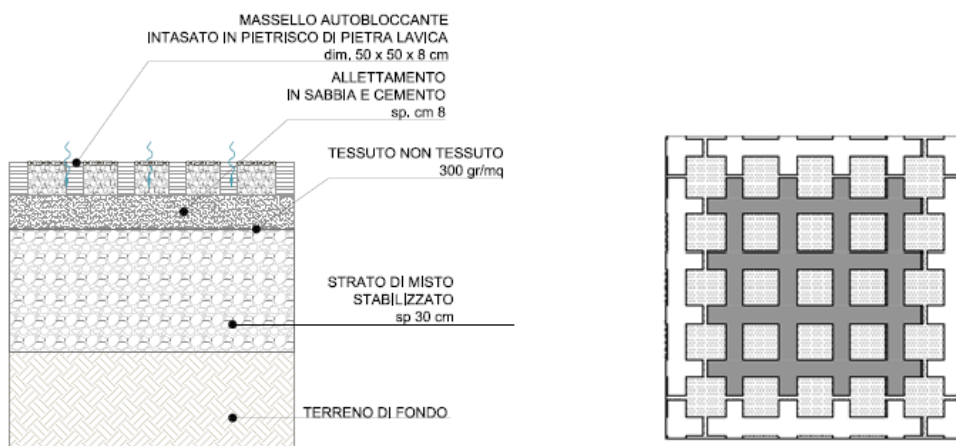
Pavimentazione aree di sosta fuori strada – Massello autobloccante intasato in pietrisco di pietra lavica.
